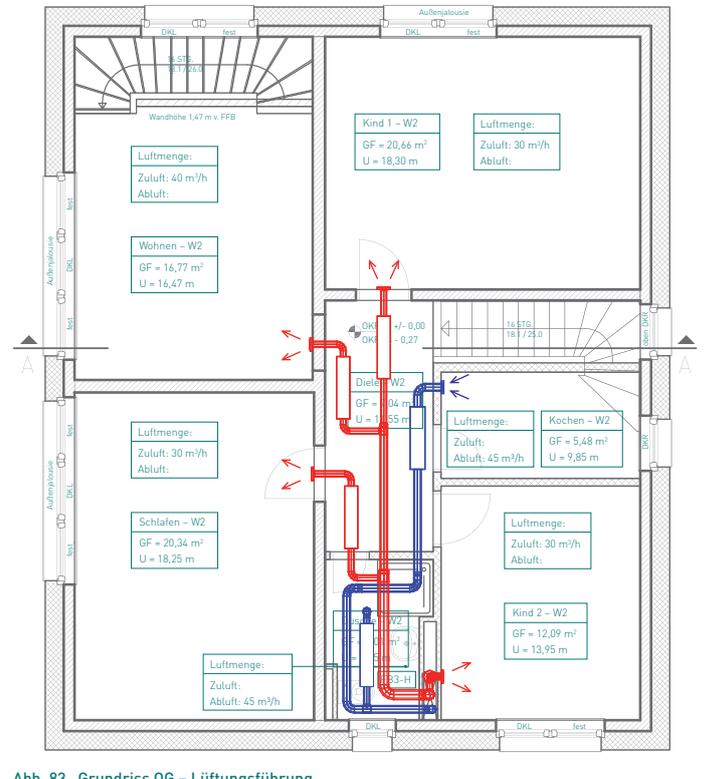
Grundriss OG – Lüftungsführung
